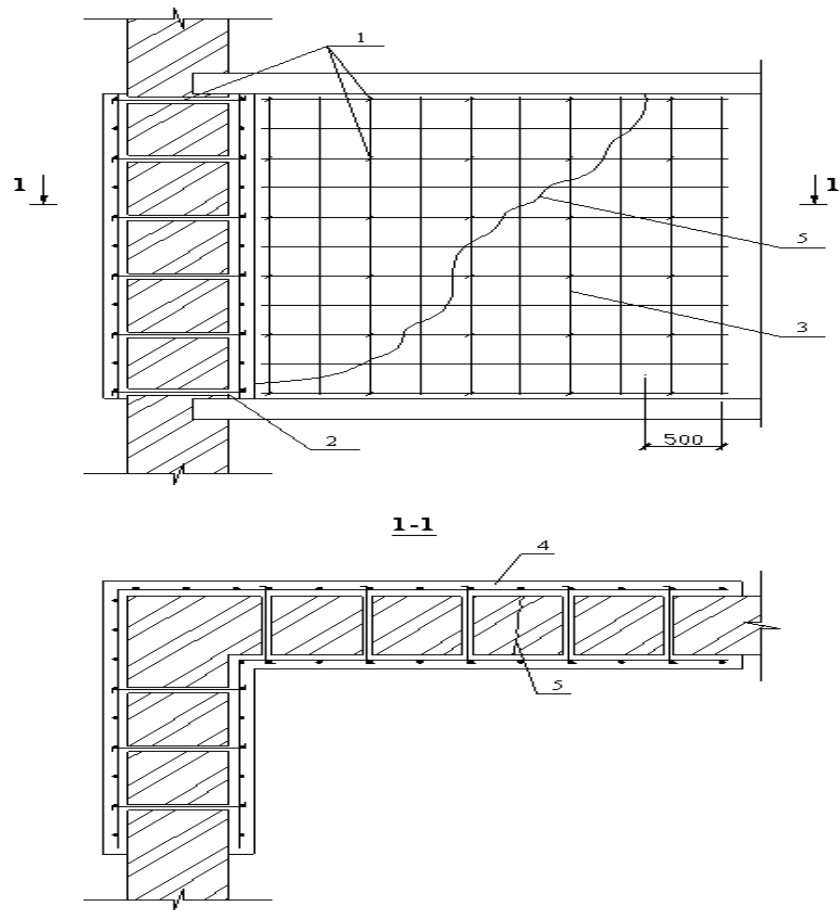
Усиление стены с трещиной арматурными сетками
